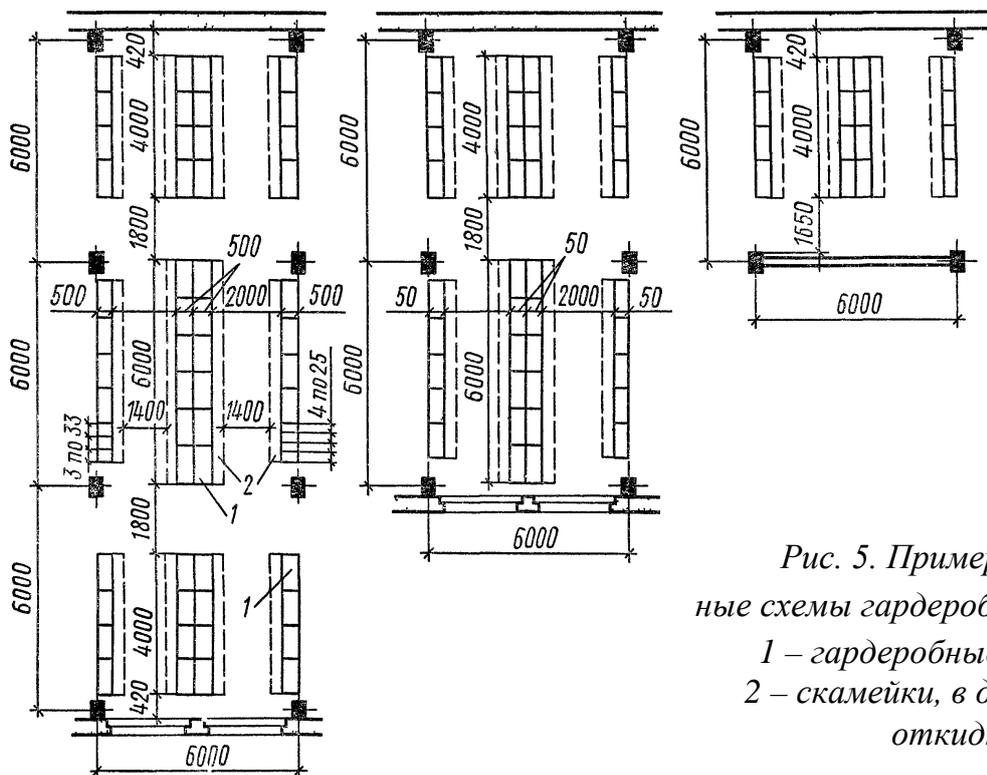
Примерные планировочные схемы гардеробных помещений:
